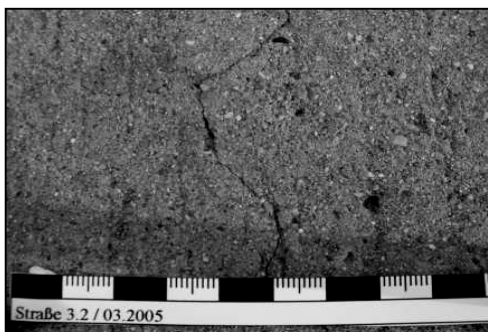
Straßenbeton 3.2: Oberflächenlängsriss nach 10 Jahren
